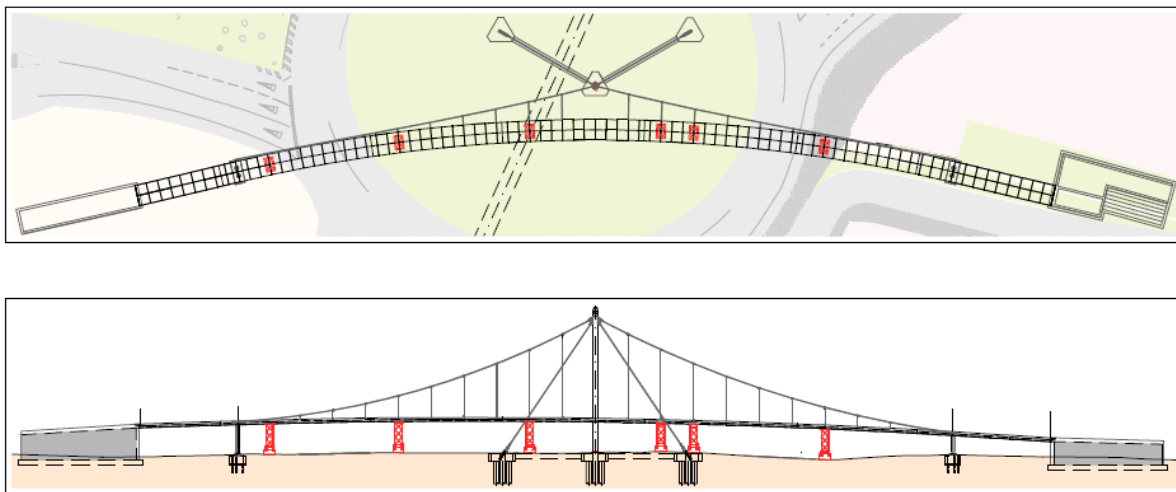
Planta y alzado de la pasarela durante el proceso de montaje.
